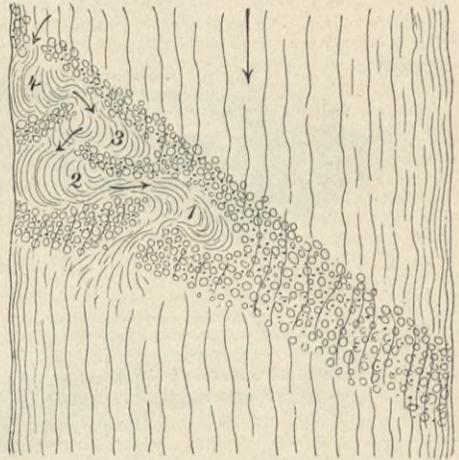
Fischweg aus Tümpeln im Schrägwehr.
